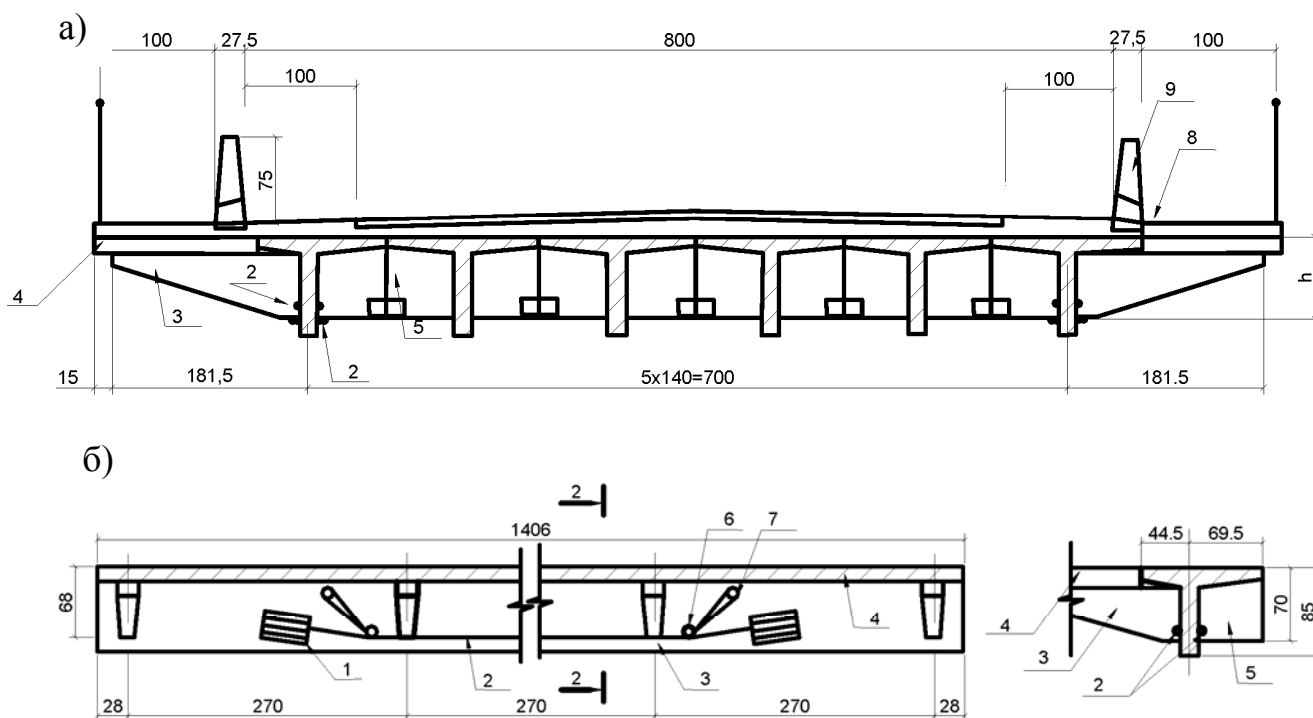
Усиление балок с каркасной арматурой внешними предварительно напряженными пучками: а – поперечное сечение моста; б – продольный разрез балки; 1 – стальной накладной анкер; 2 – напряженный пучок; 3 – бетонизируемая ж/б диафрагма; 4 – ж/б плита уширения; 5 – стык диафрагмы; 6 – оттягивающее устройство; 7 – стальной внутренний цилиндрический анкер; 8 – стальной лоток водоотвода; 9 – парапетное ограждение
